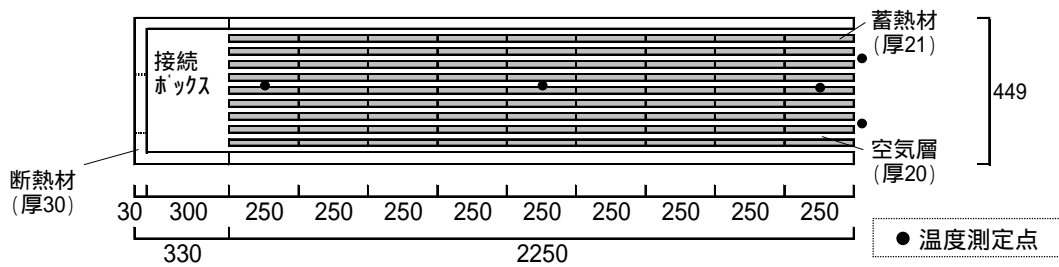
(b) 蓄熱体断面図 (X-X 断面)
